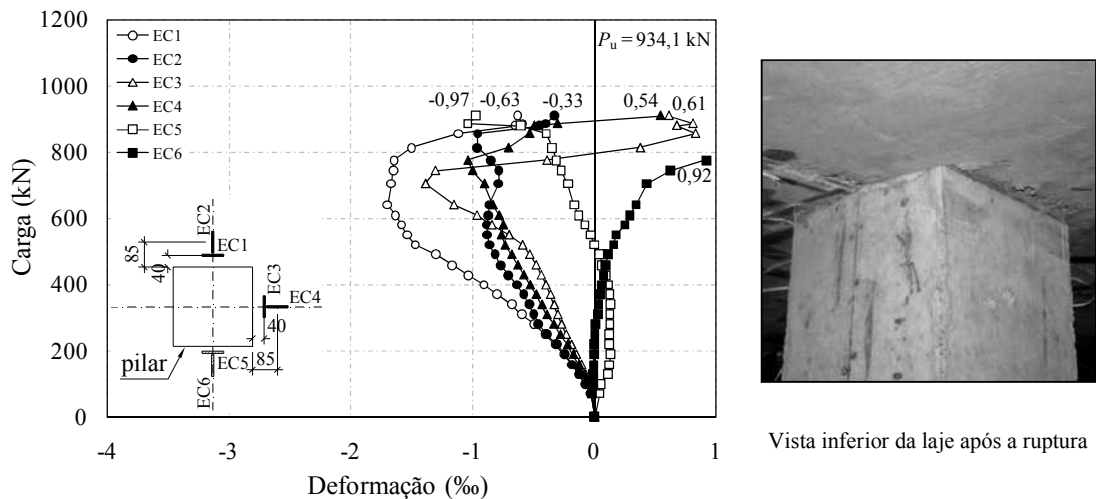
Deformações na superfície do concreto da laje LS08
